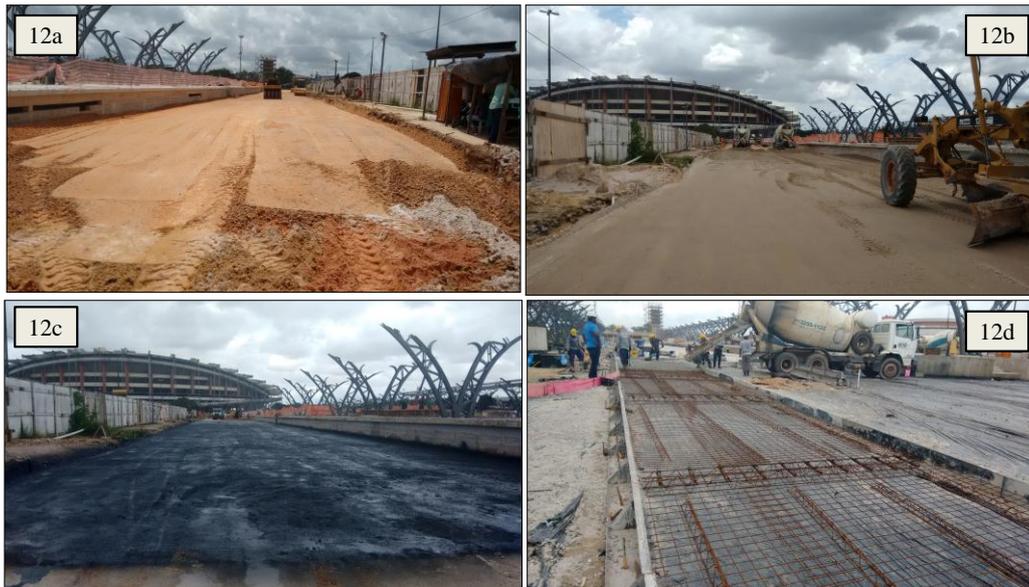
Etapas de execução do pavimento rígido do Terminal Mangueirão (Silva et al., 2018)
